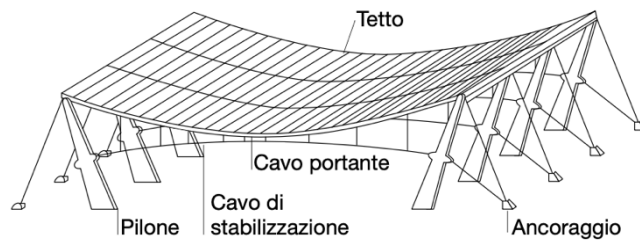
Travi di funi a sistema aperto con collegamenti verticali
